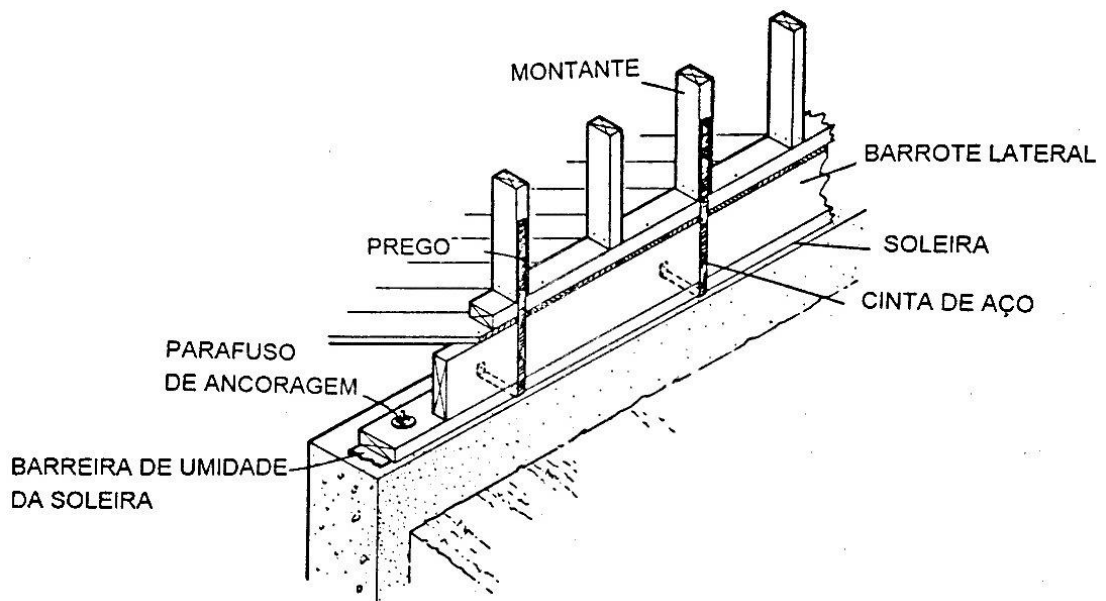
Detalhe da ligação da estrutura de madeira com a base de concreto
